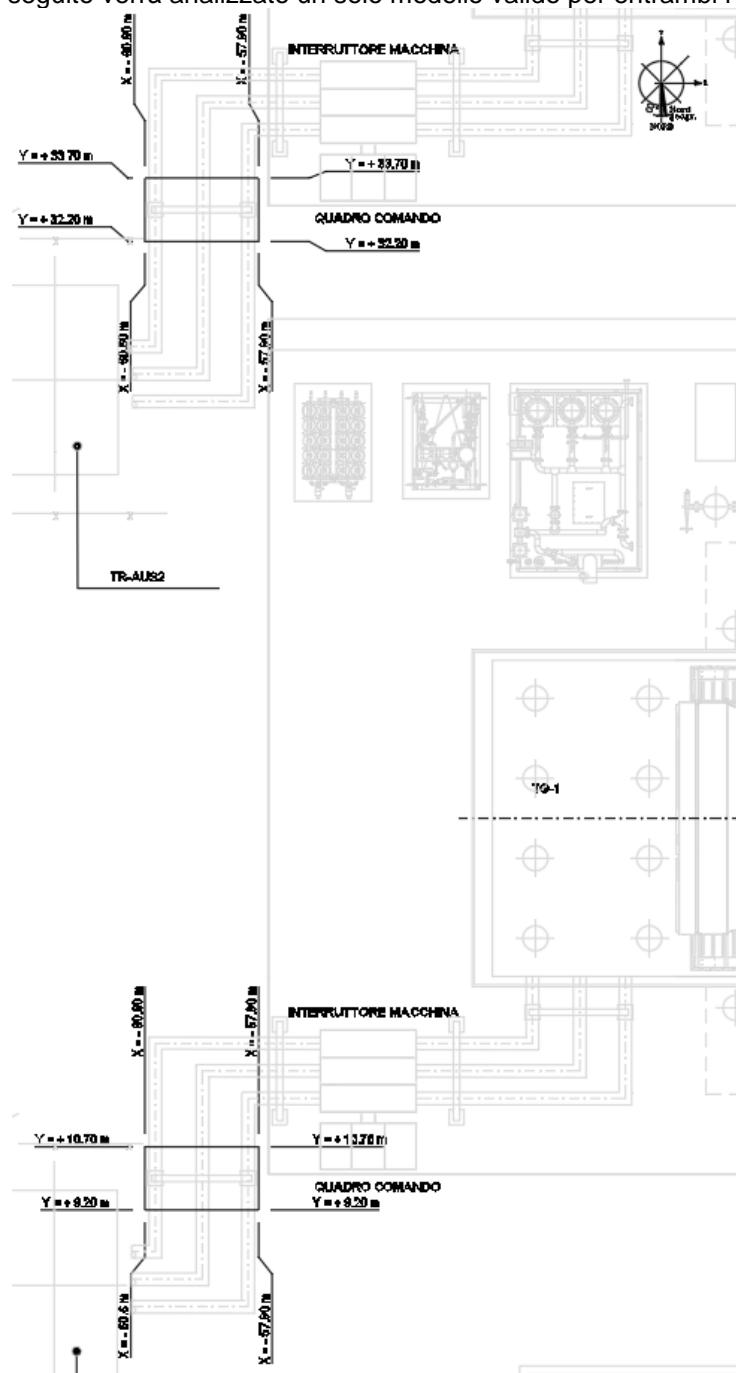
Ubicazione delle fondazioni condotto sbarre
